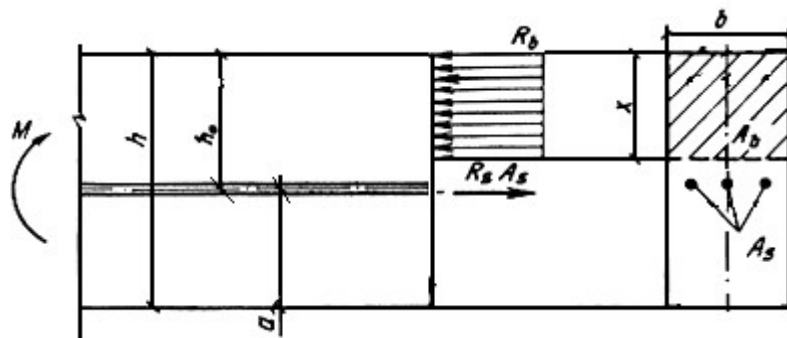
Схема усилий в поперечном прямоугольном сечении изгибаемого железобетонного элемента
